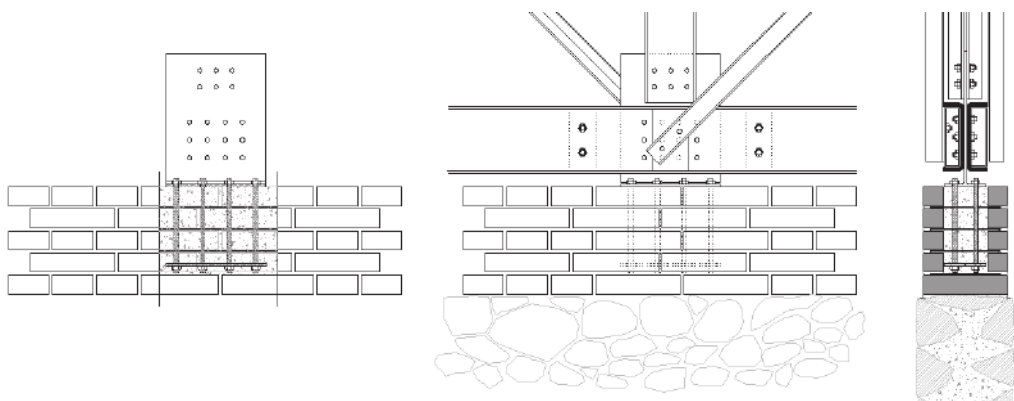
Pianta dei corsi, prospetto e sezione trasversale del cordolo in muratura con collegamenti puntuali
